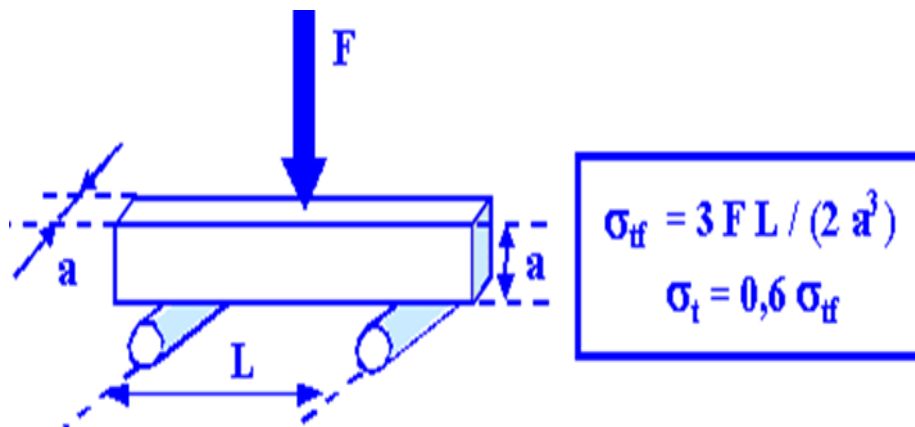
Déroulement de l'essai de flexion trois points pour éprouvettes prismatiques de mortiers 40 x 40 x160 mm.
